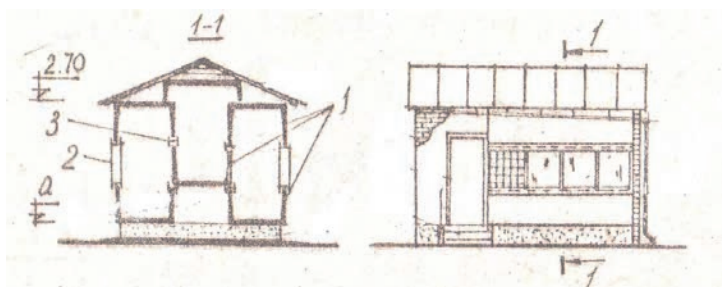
Хозблок из сборных лотков для канальной прокладки теплотрасс, кабелей и т. п.:
